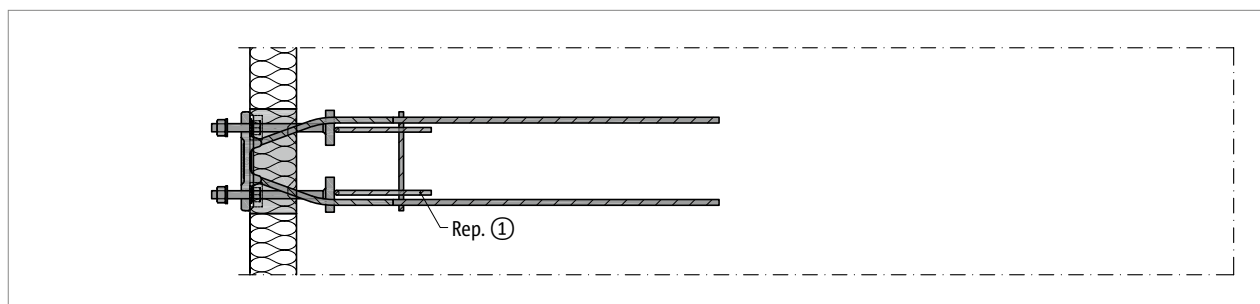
Schöck Isokorb® T type SQ : armatures à prévoir par le client, vue en plan
